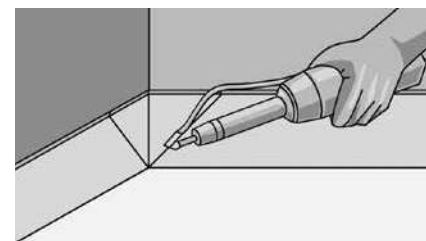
Для соединения стыков используйте метод горячей сварки и необходимое оборудование.
